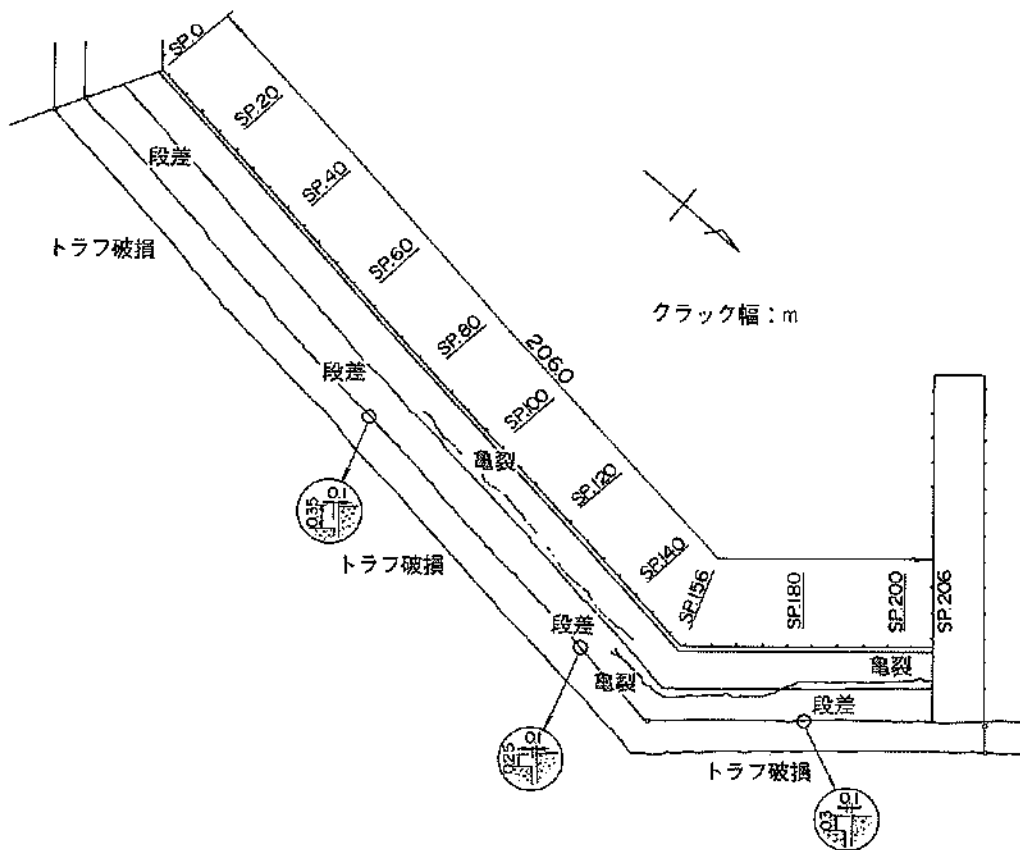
エブロンクラック平面図 (副港地区, ⑧岸壁(-5.0m))
